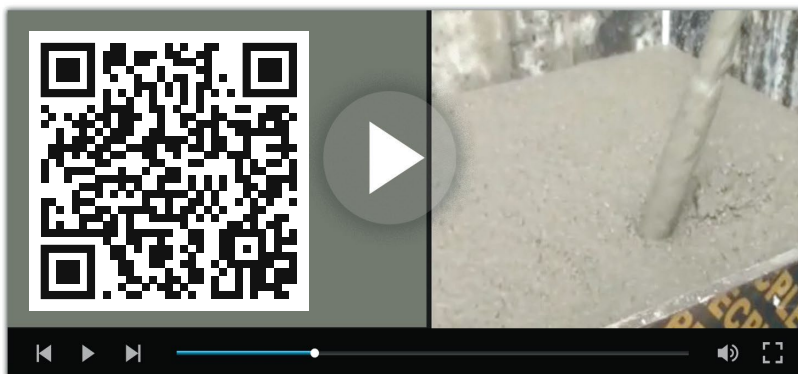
Proceso de vibrado de un elemento horizontal donde se aprecia el correcto compactado.
